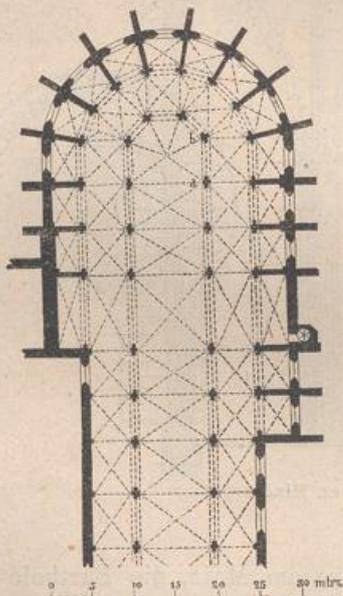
Kirche zu Zwettl. Grundriss.
